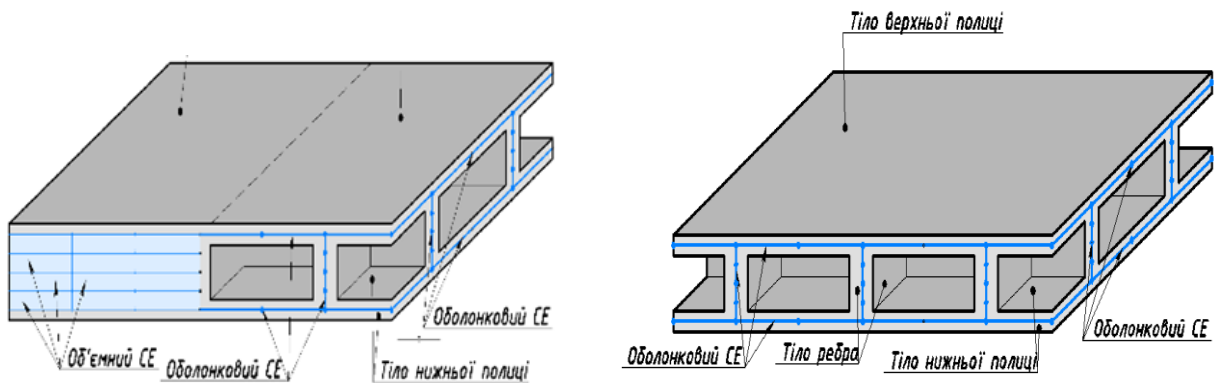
Схема моделювання плити перекриття оболонковими елементами
